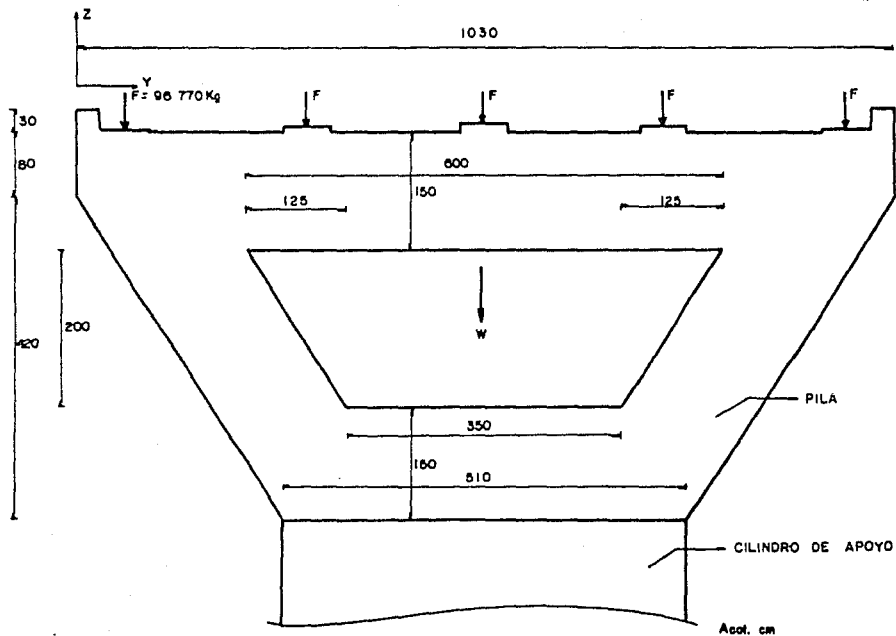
Pila número 2.- Dimensiones, sistema de cargas y de apoyo, donde la planta de la pila es la misma que la de la pila número 1.
